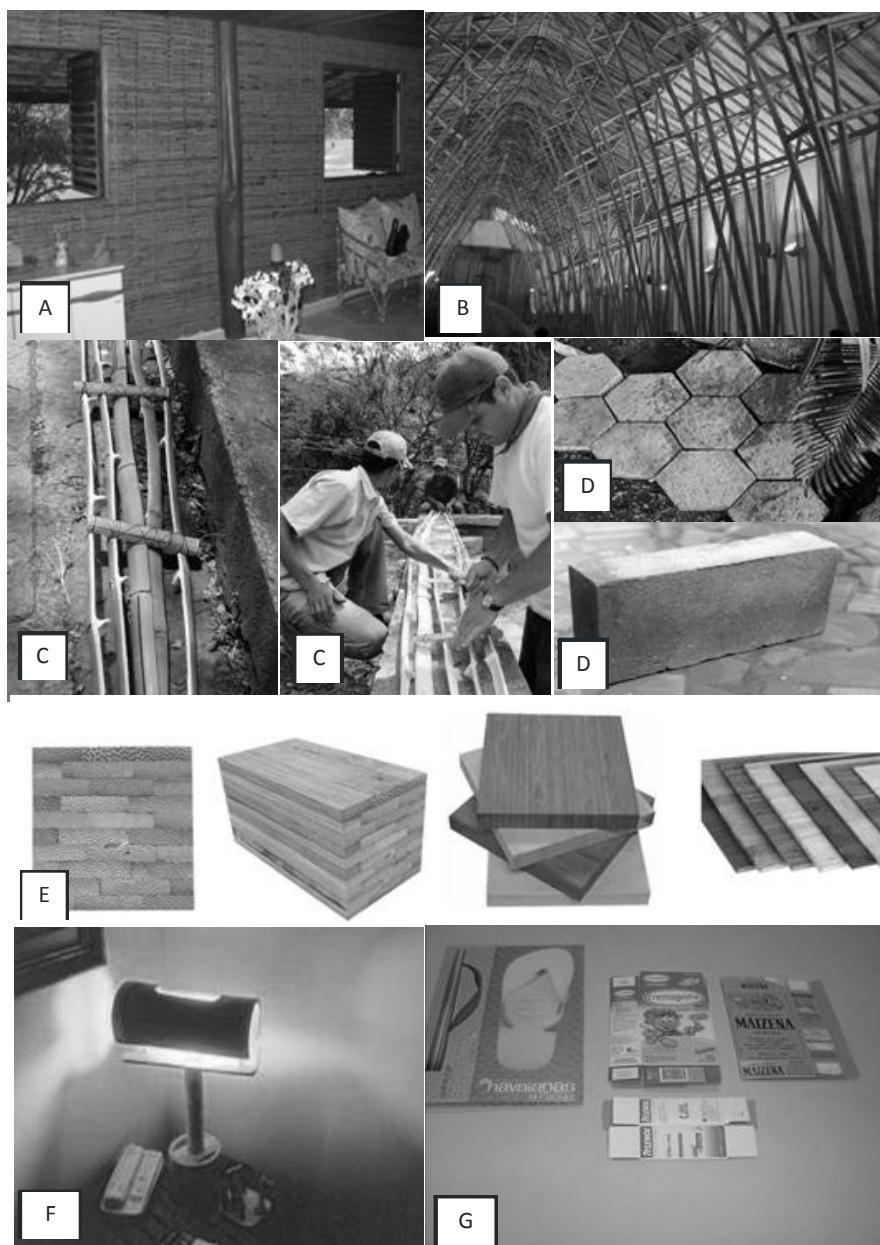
A – PAINEL DE VEDAÇÃO; B – ESTRUTURA DE CONSTRUÇÃO (VIGAS E PILARES); C – BAMBUCRETO; D – BIOKRETO; E – BAMBU LAMINADO COLADO; F – ARTEFATO EM BAMBU; G – PAPEL PARA EMBALAGEM.
